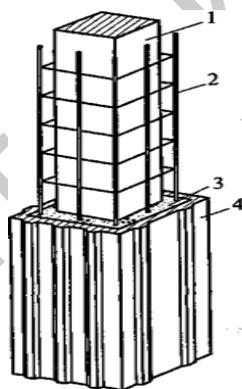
Усиление сваи с использованием железобетонной обоймы: 1- ствол
